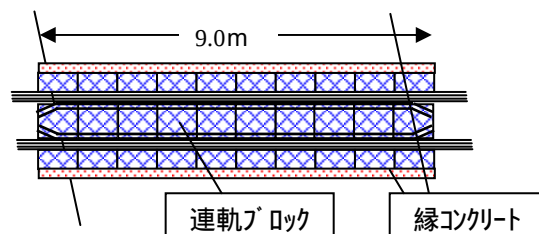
：太郎田連接軌道踏切の平面図（幅員 7.3m）
